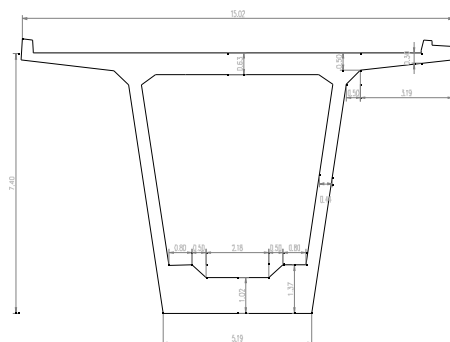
Corte transversal do tabuleiro na zona dos apoios sobre os pilares.
